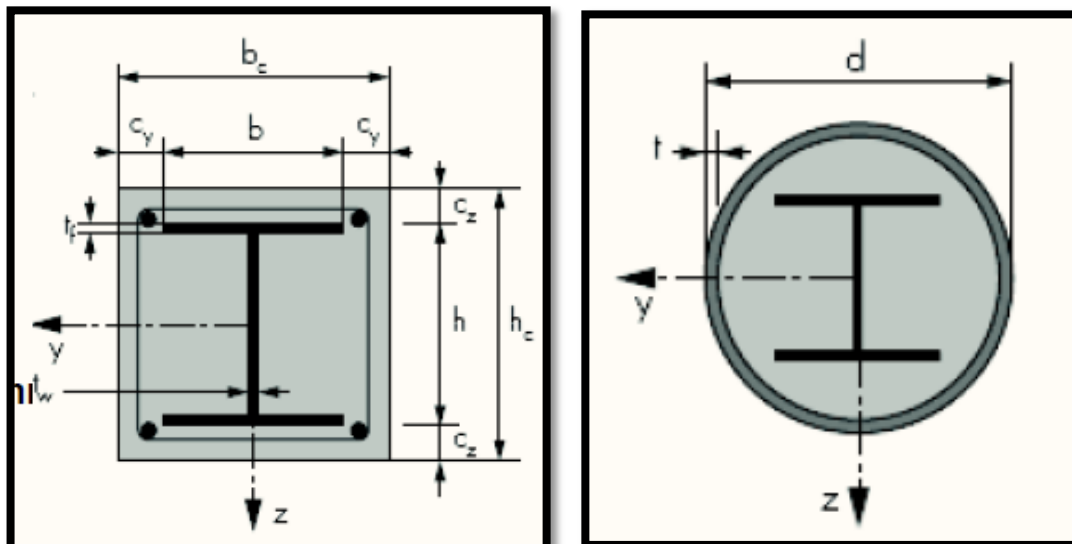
schéma d'un poteau métallique section rectangulaire et circulaire avec profilé métallique enrobé de béton
